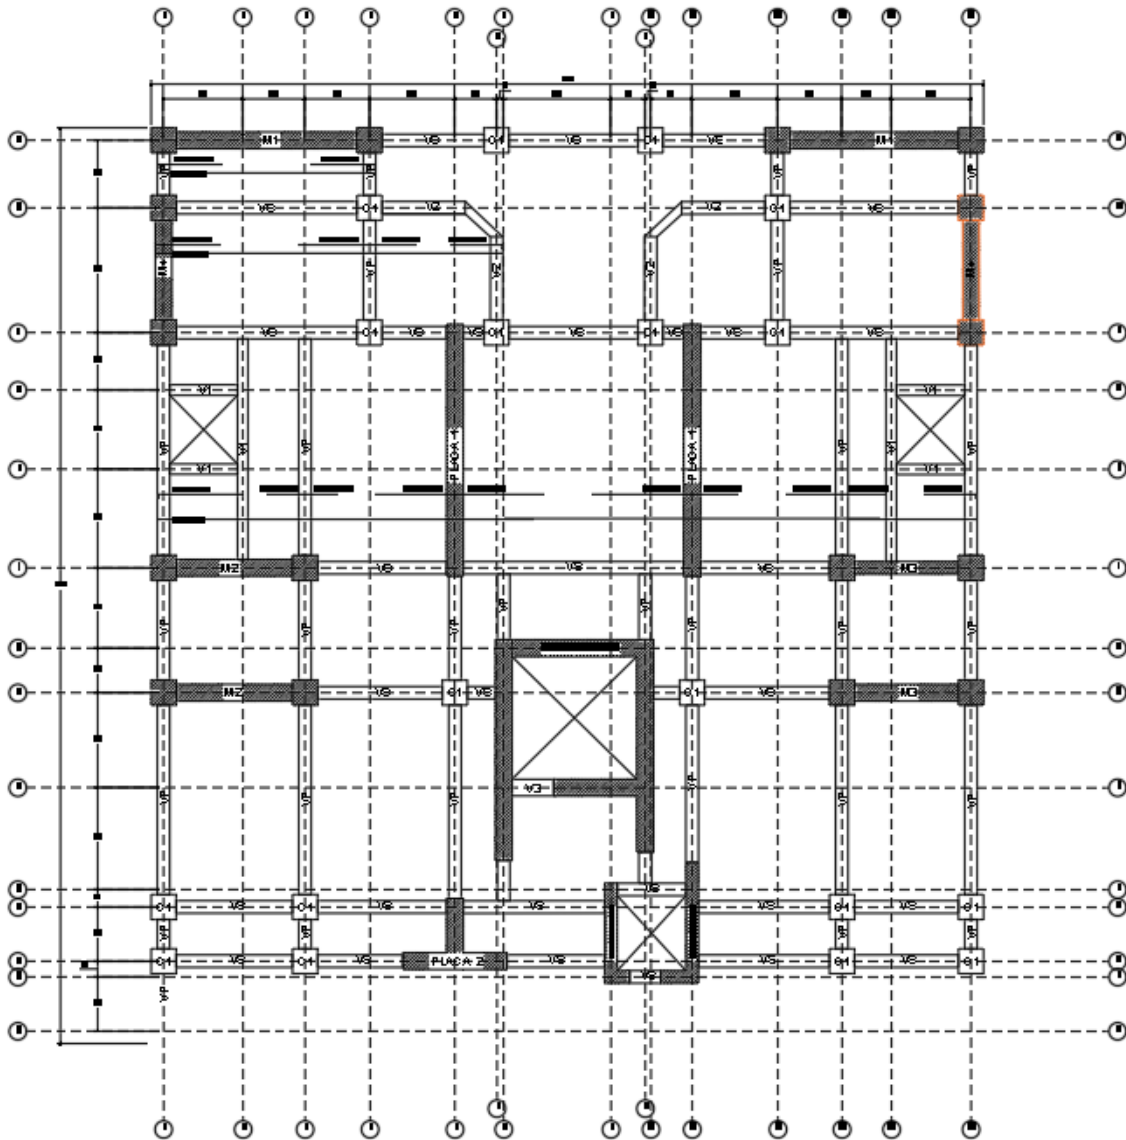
Diseño del acero positivo y negativo de la losa aligerada y maciza del piso más crítico del concreto
